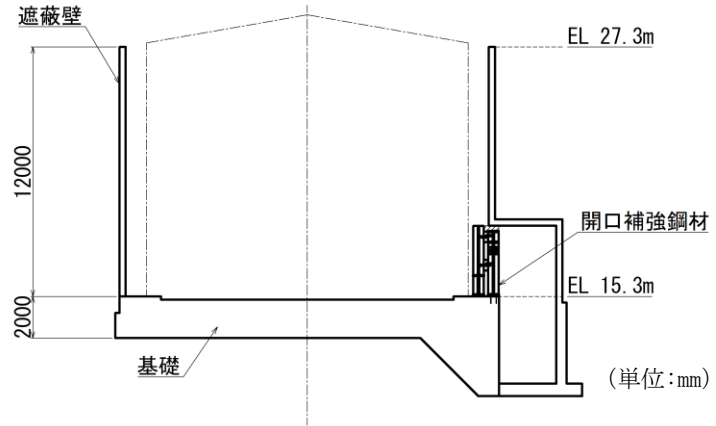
補助復水貯蔵タンク遮蔽壁 平面図 (A-A断面)
